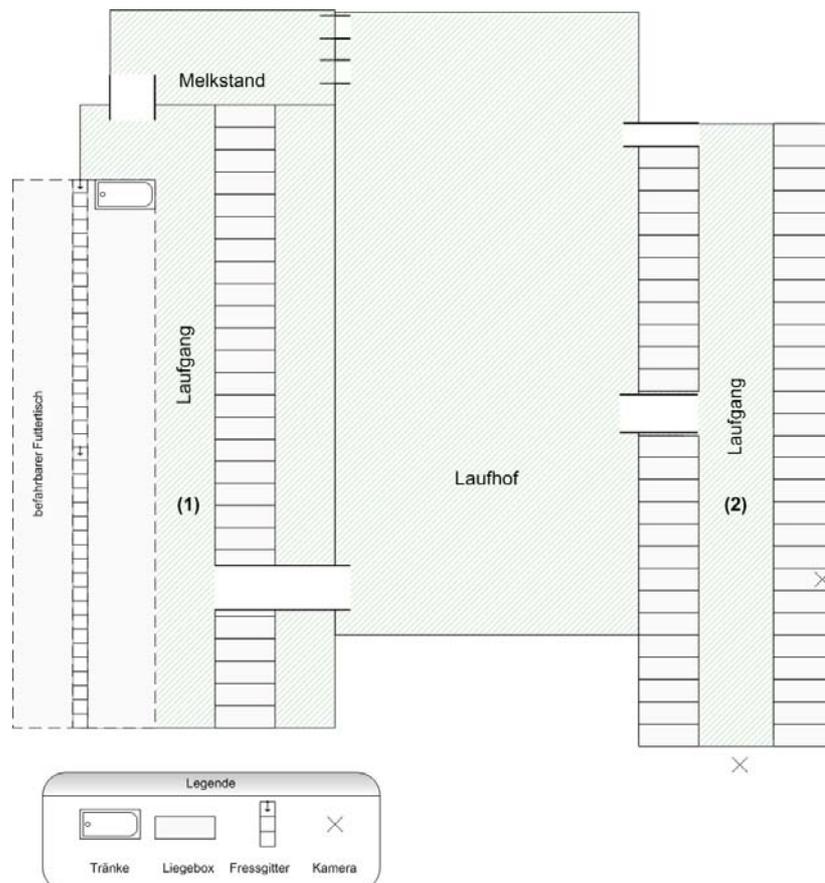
Grundriss des Milchviehbetriebes
